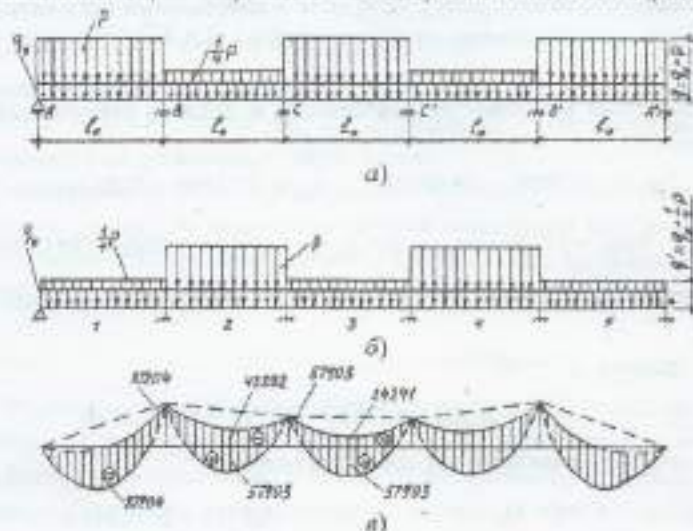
Построение огибающего эпюра моментов второстепенной балки: а - при загрузке по схеме 1; б - при загрузке по схеме 2; в - эпюр моментов; 1 - 3 - номера пролетов
